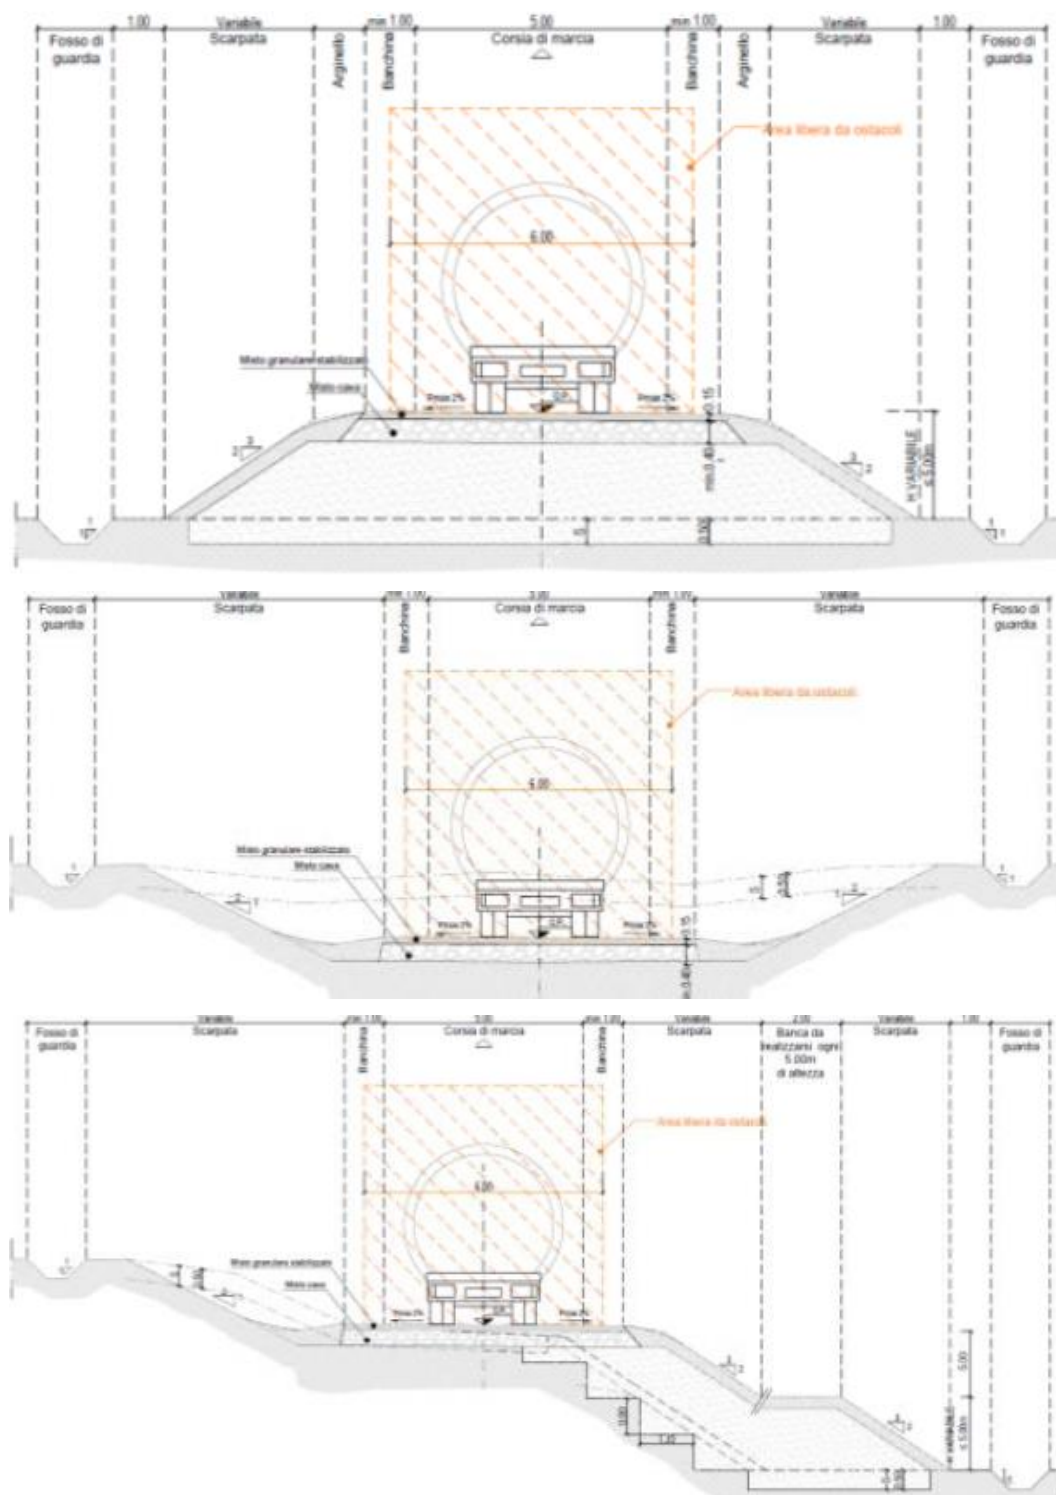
Sezione tipo in rilevato, trincea e mezzacosta
